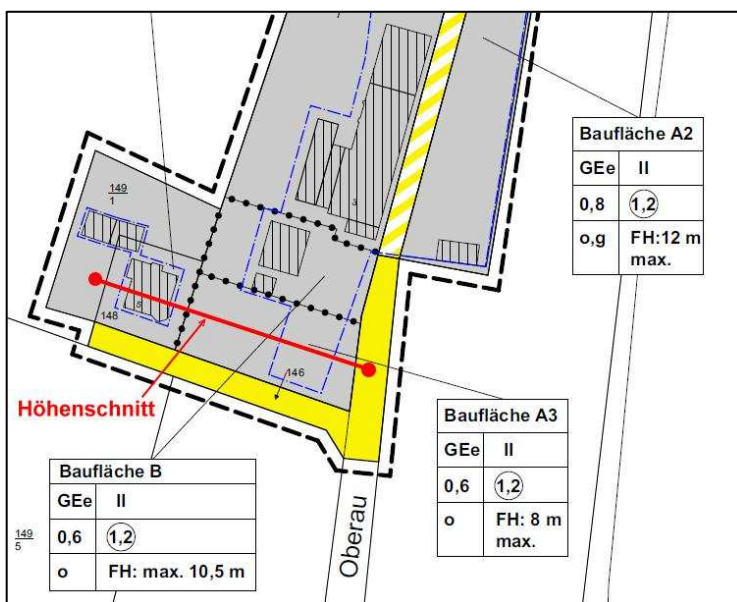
Anordnung Höhenschnitt im Plangebiet (Ausschnitt B-Plan, ohne Maßstab, genordet)
